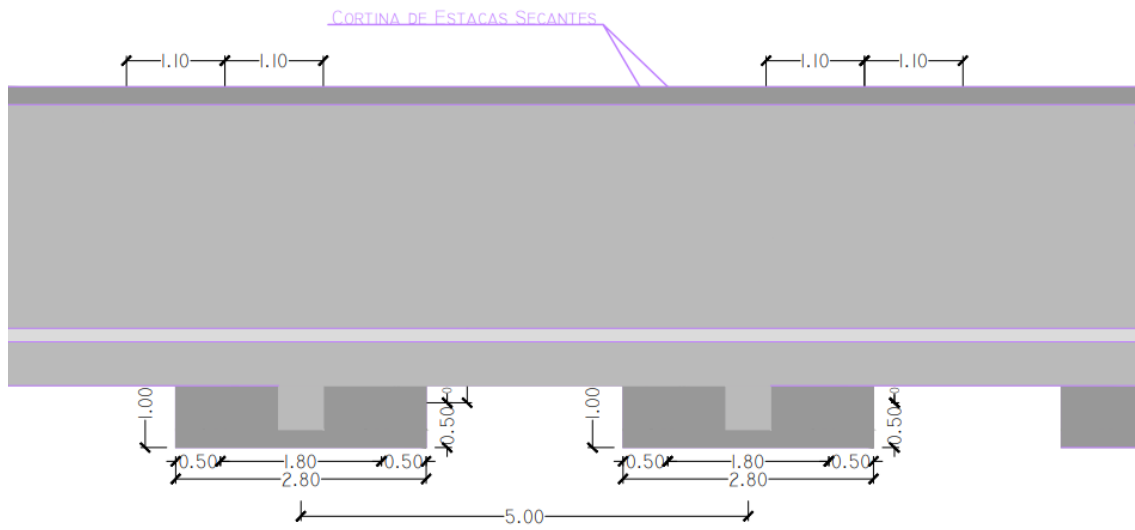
Corte. Estrutura de Retenção a Montante. Fonte: Projegui.
